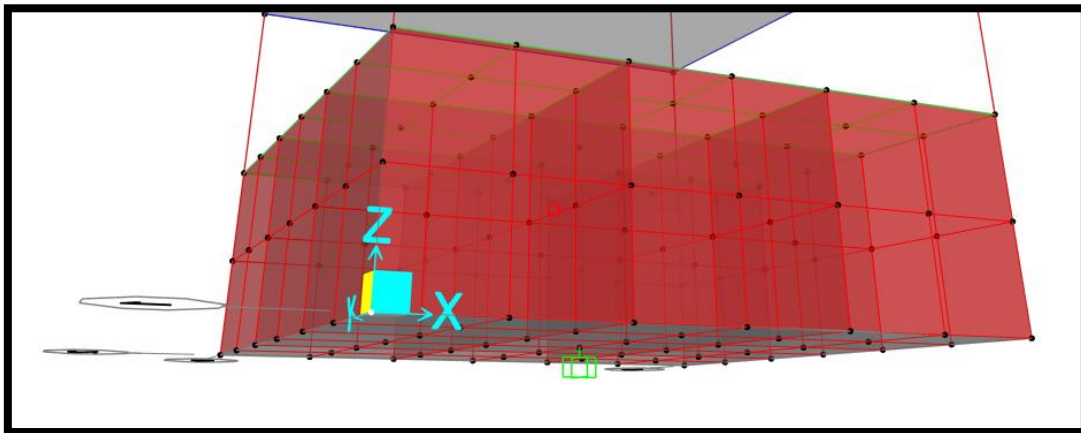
Cajón de cimentación con nodo maestro empotrado en su centro geométrico.
